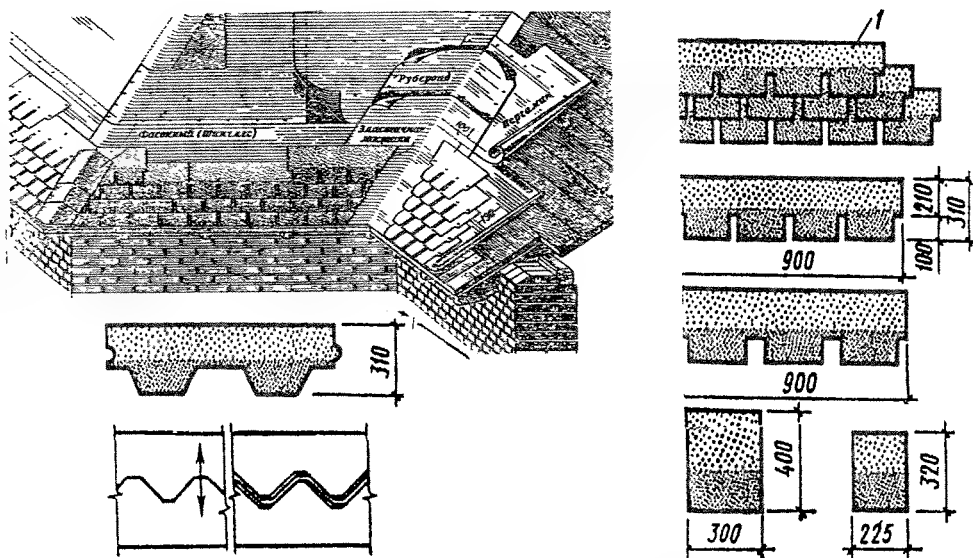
Кровля из бронированных рубероидных битумных плиток:
